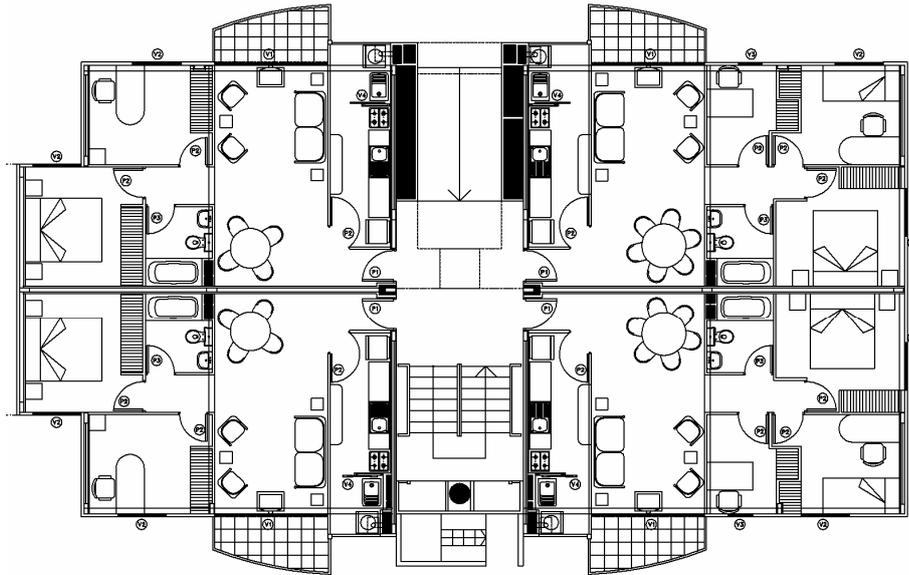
Edificios A y E, planta Piso Tipo.
